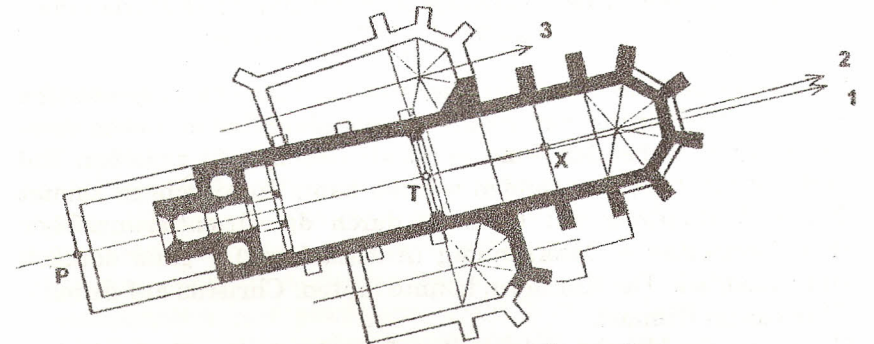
Grundriss der Pfarrkirche von Marchegg mit Orientierung von Langhaus, Chor und nördlicher Seitenkapelle (schwarz: heutiger Bestand). Norden ist oben.
